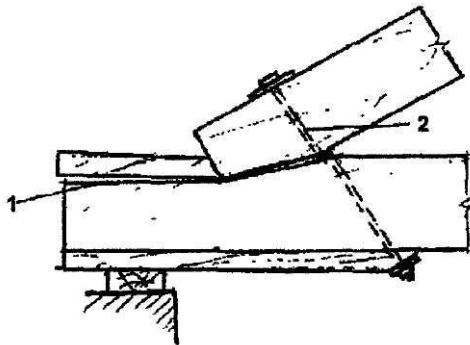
Скалывание площадки в лобовой врубке, могущее привести к обрушению всей конструкции:
